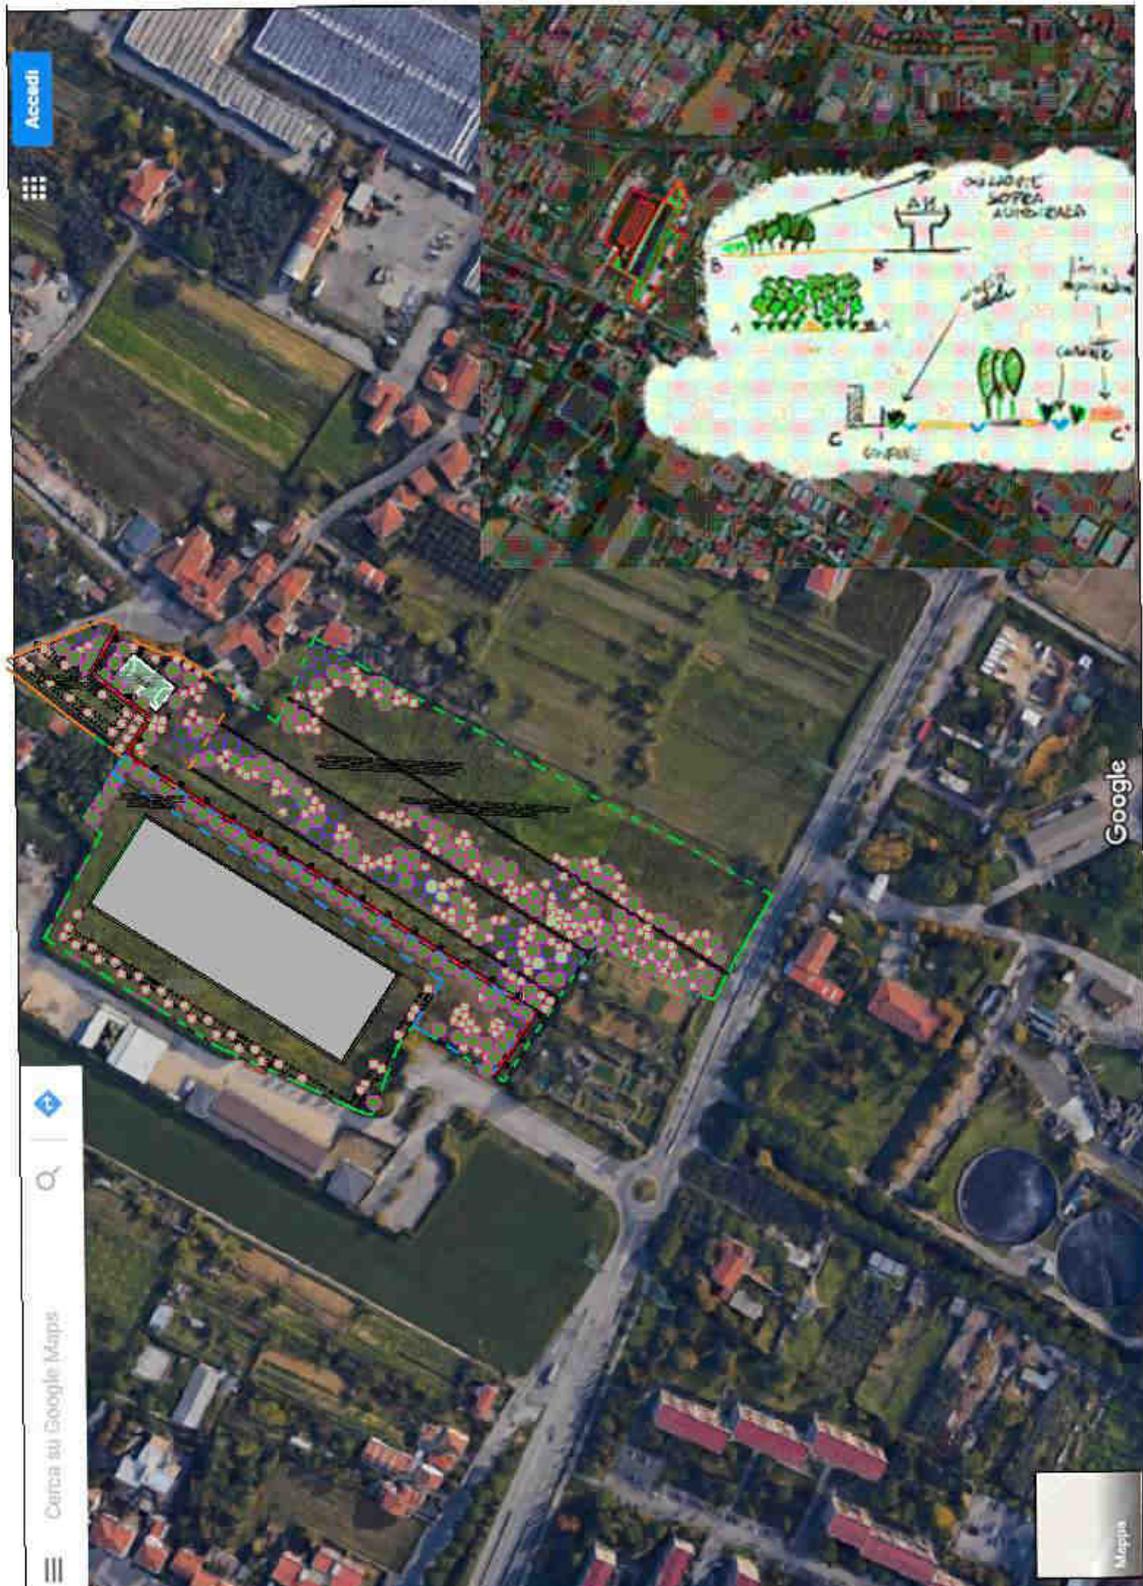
planimetria di progetto su ortofoto 2019 regione toscana
